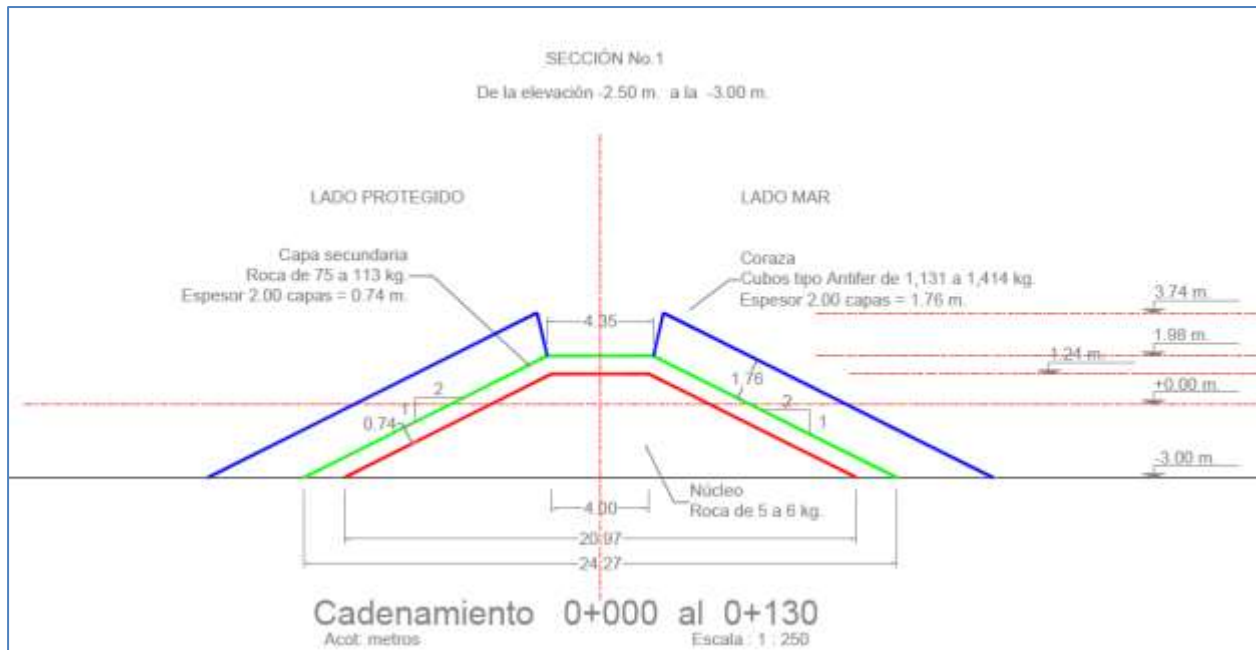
Sección 1 con cubos en la coraza cadenamiento
